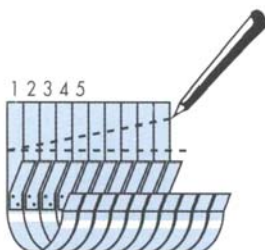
Sposób montażu haków skrajnych do deski czołowej z rozciągnięciem sznurka. [folder producenta]
